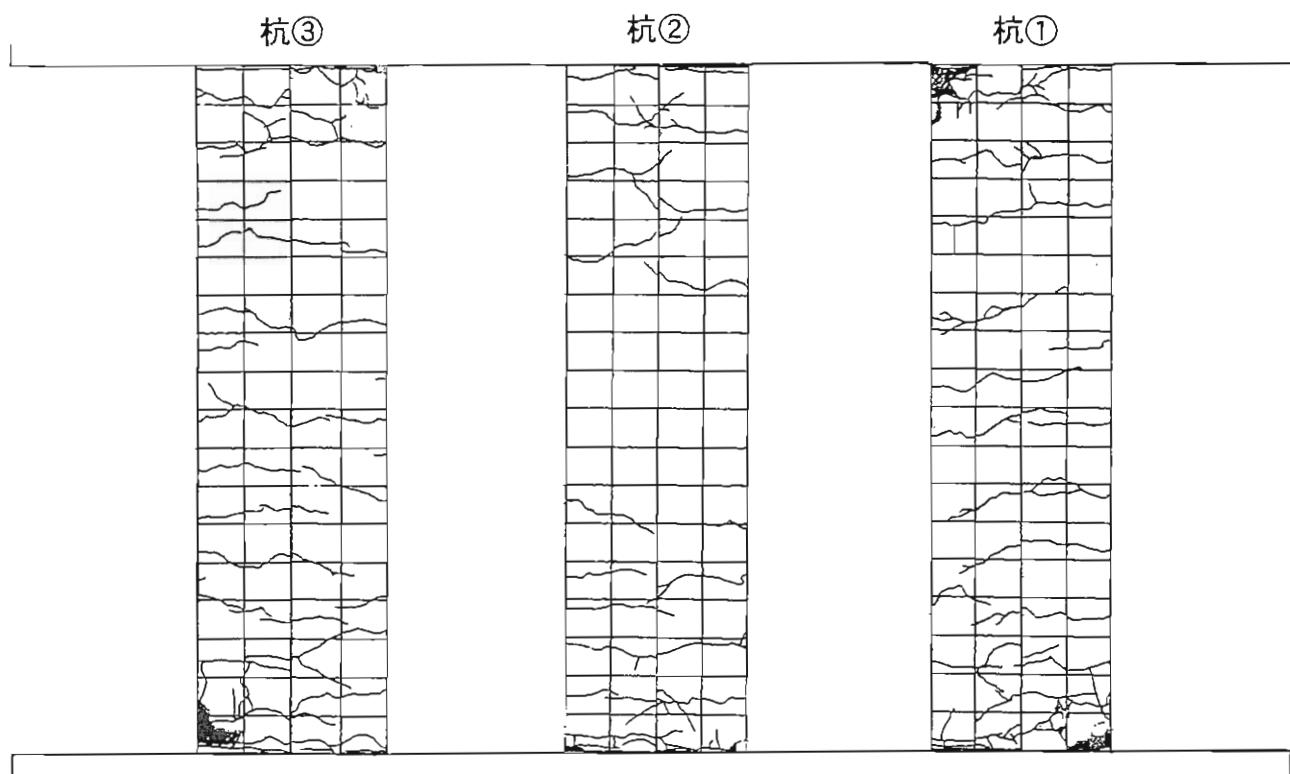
桁体のひび割れ状況展開図（ケース1、 $4\delta_y$ ）
